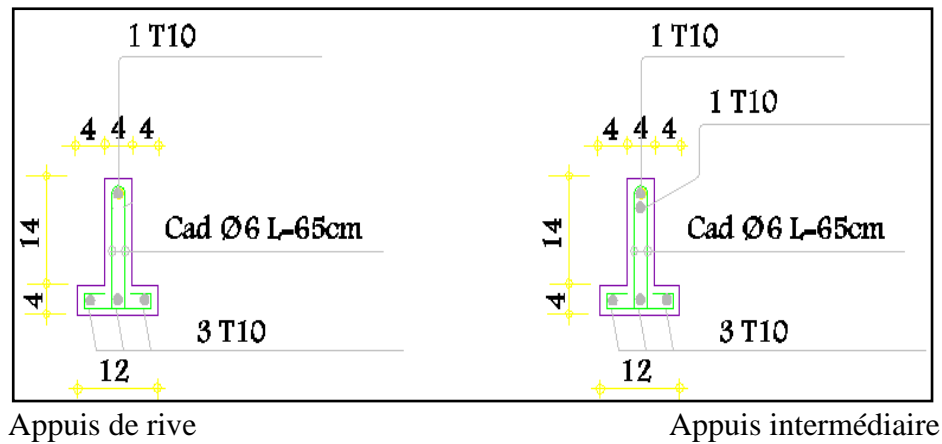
Dessin de ferrailage des poutrelles des étages courants.
